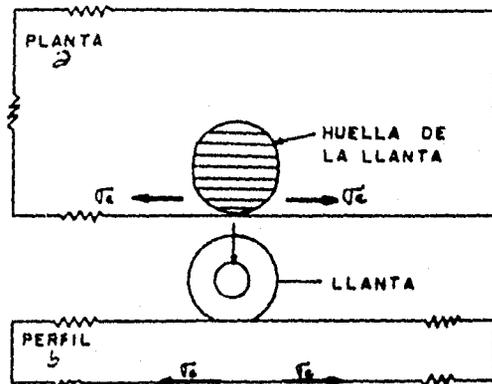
Esfuerzos de tensión que se presentan en pavimentos rígidos en el caso que la huella de una llanta sea tangente a una sola orilla de la losa (esfuerzos de orilla), (a) planta, (b) sección.
